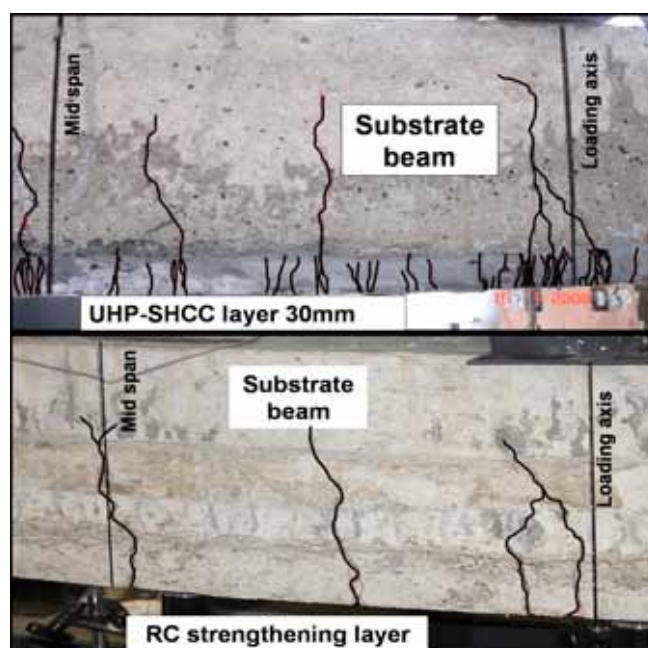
モーメントスパン内のひび割れ性状（上図：UHP-SHCC 厚 30mm，下図：RC 層）
